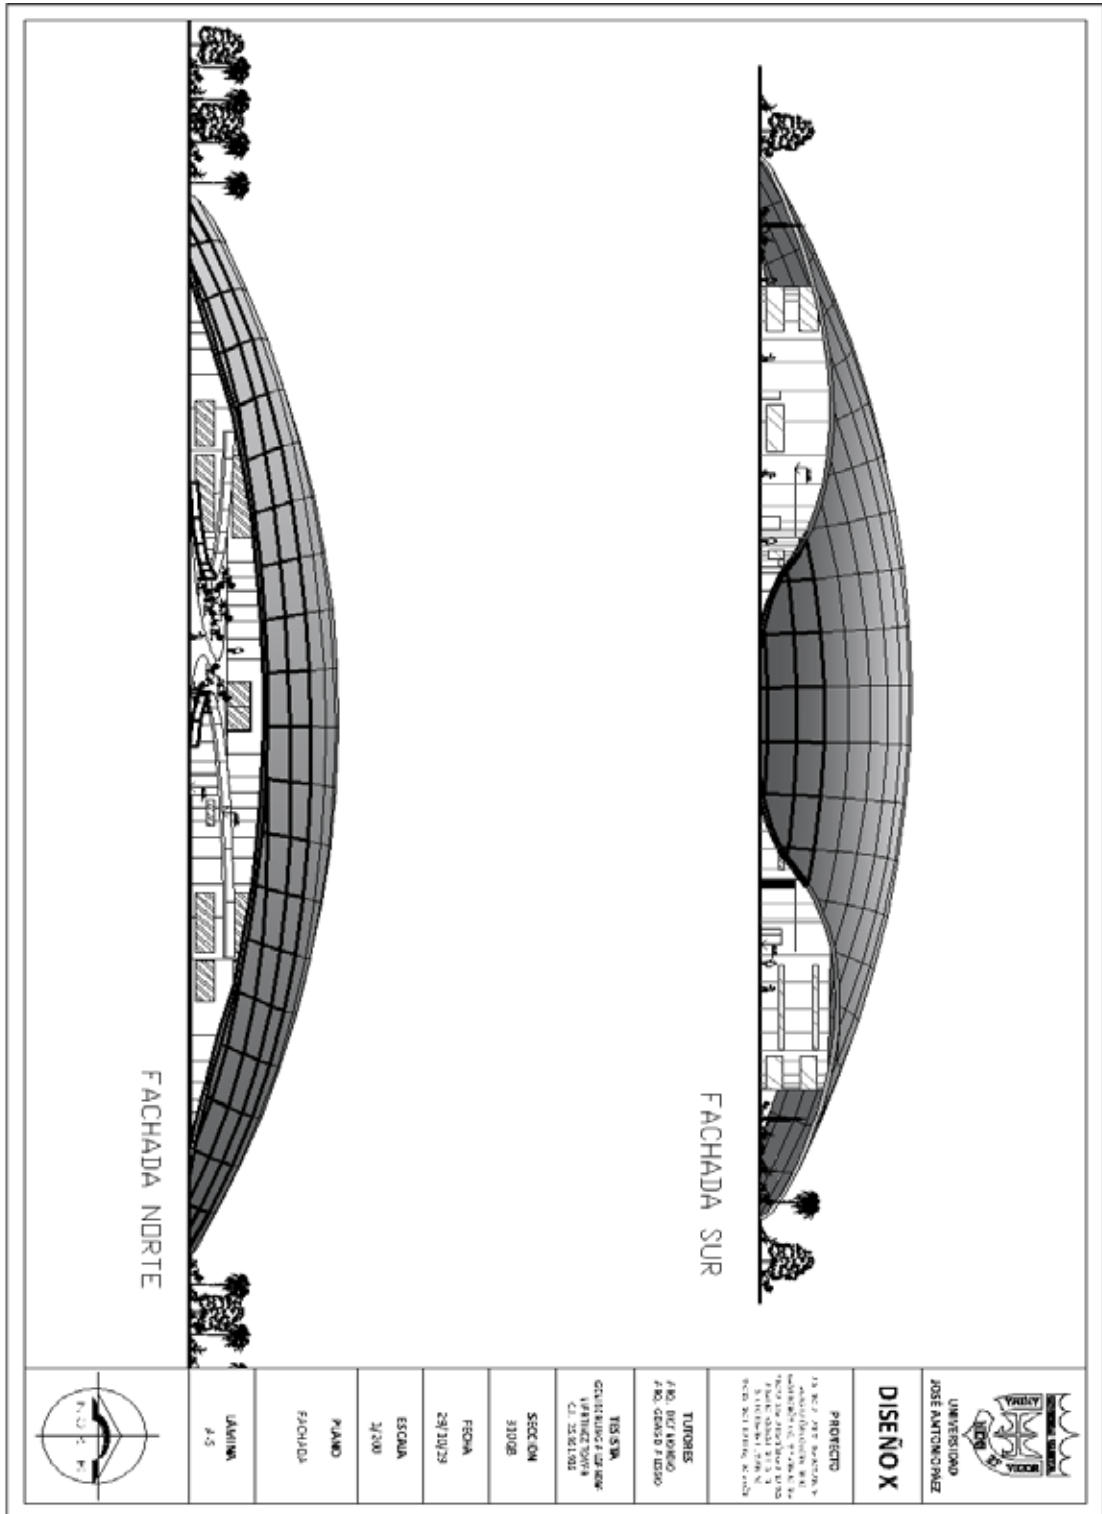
Alzado Norte y Sur. Autor: Gemberling Martínez (2018)
